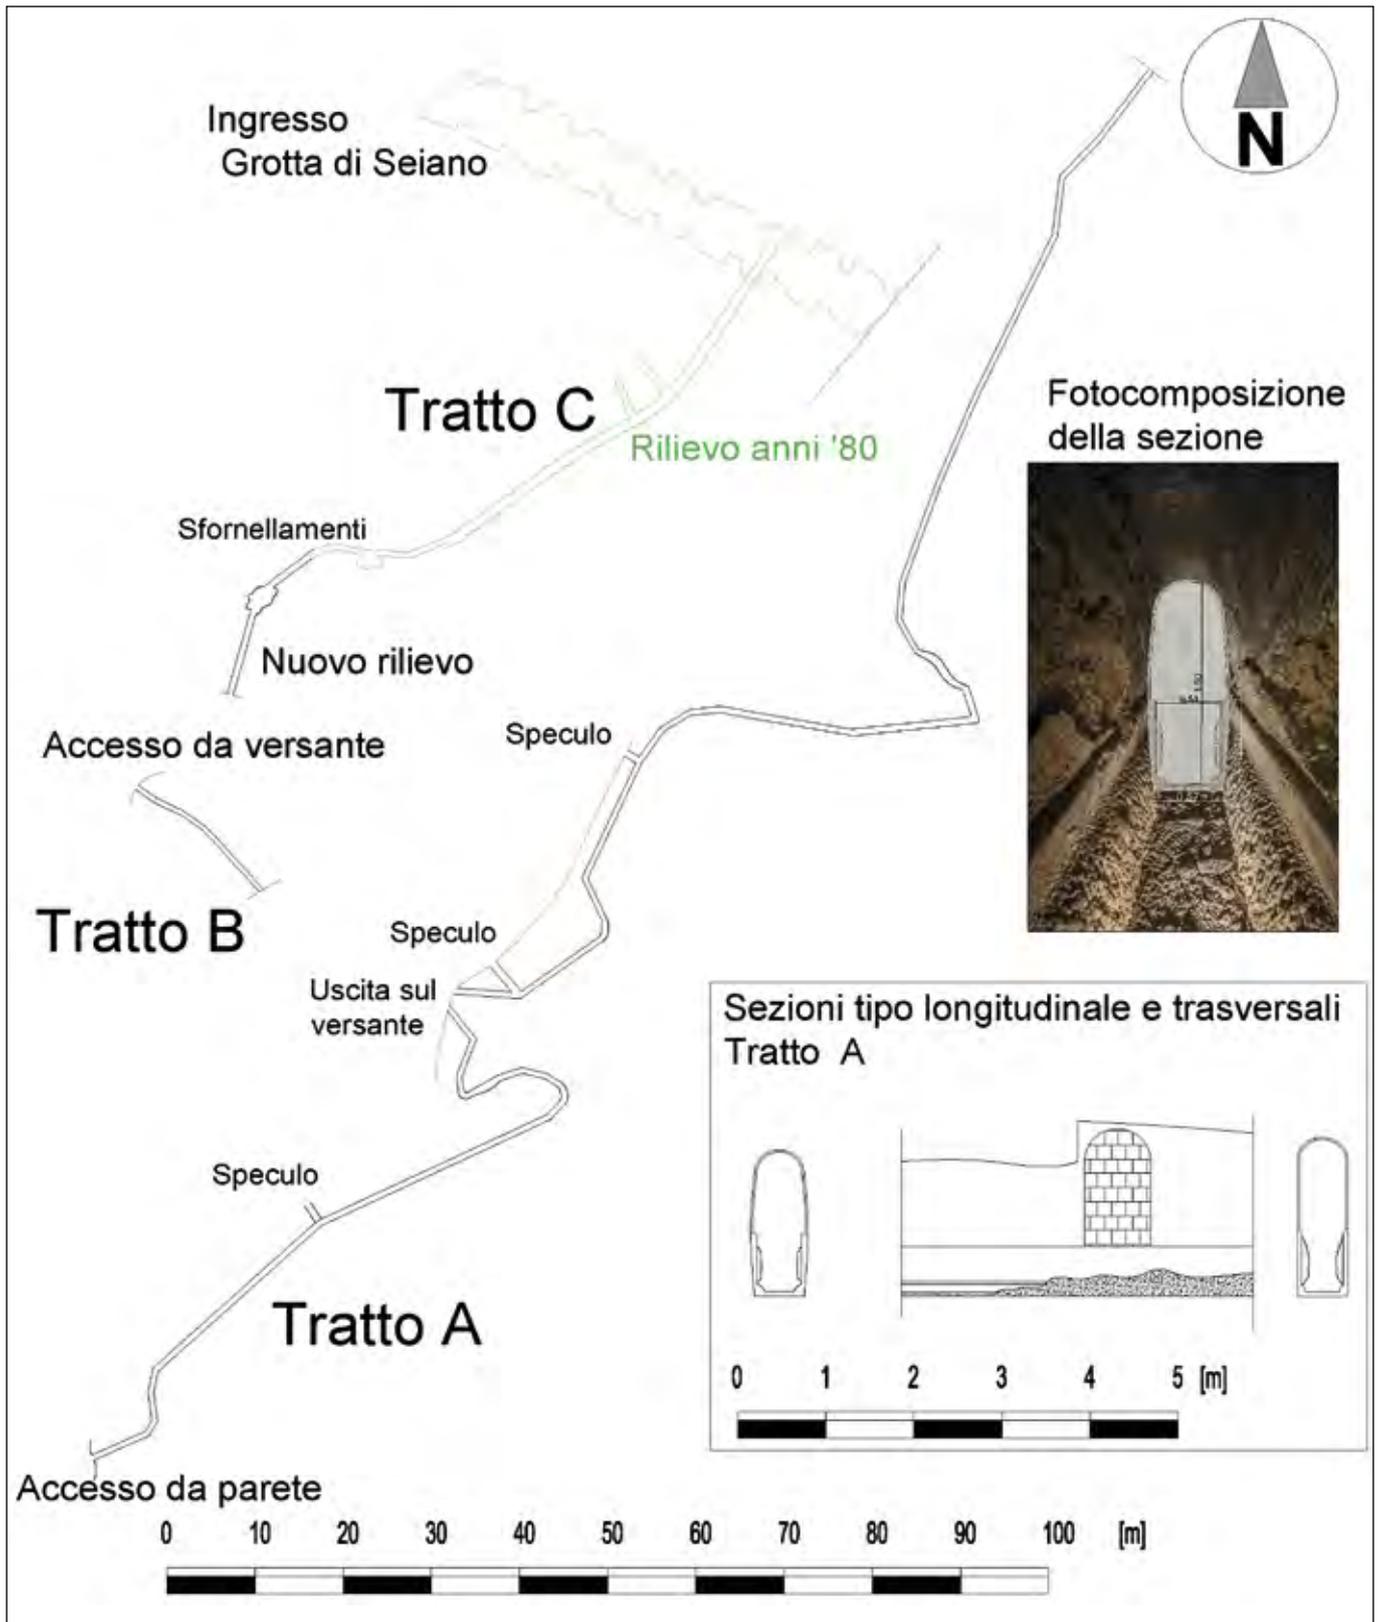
Piante e sezioni dei tratti rilevati 2019
